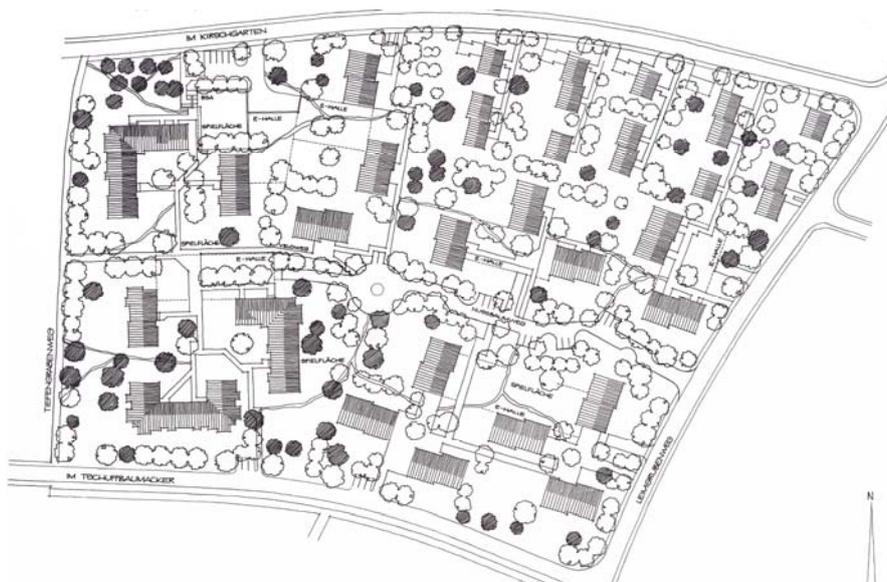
Rechtsgültiger Quartierplan „Kirschbaumacker“, Gestaltungsplan
